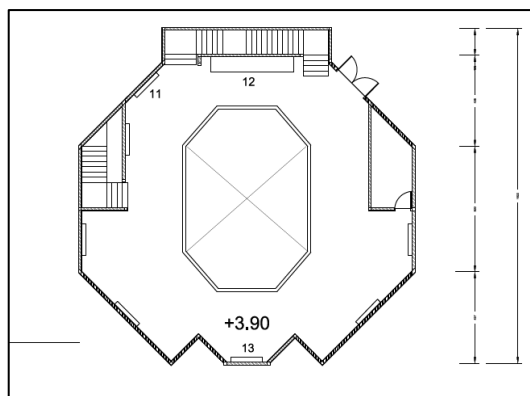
9 Alternatif 3 Denah Lantai 1
